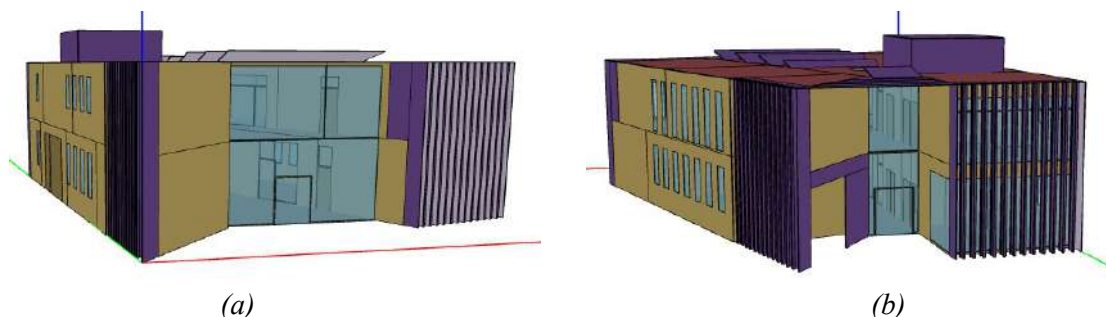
Render de modelado edificio, (a) vista sur, (b) vista norte.
